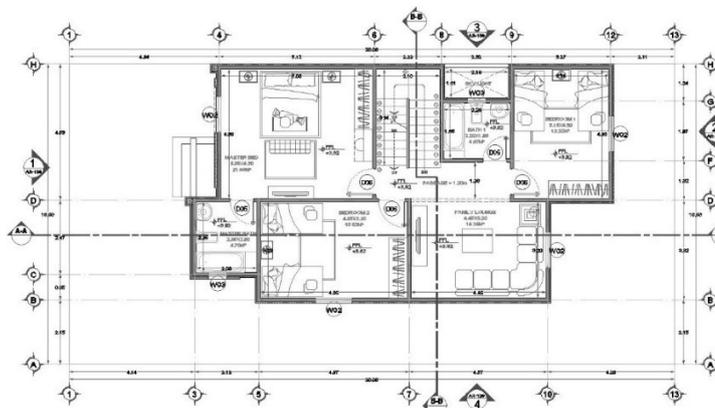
Planta alta arquitectónica. Proyecto Al Olaya.
